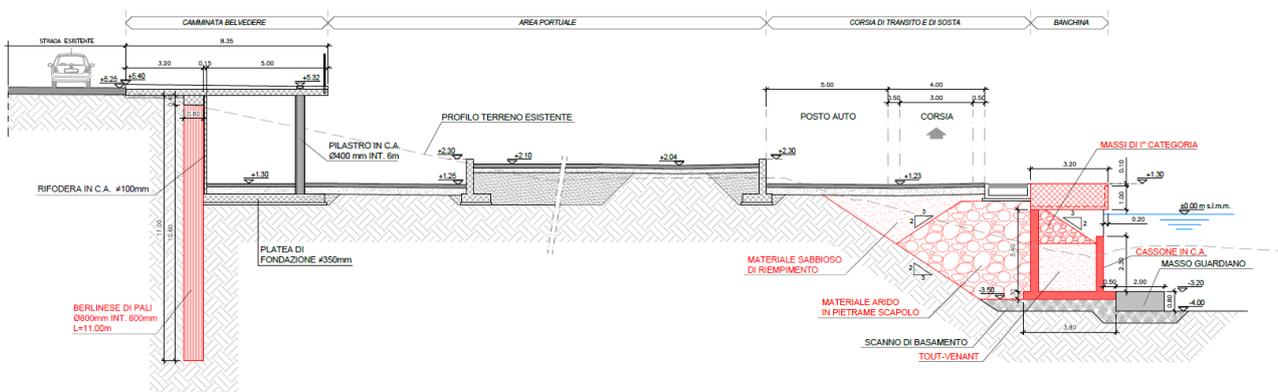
Sezione di progetto su circolo nautico – collegamento con viabilità esistente.
